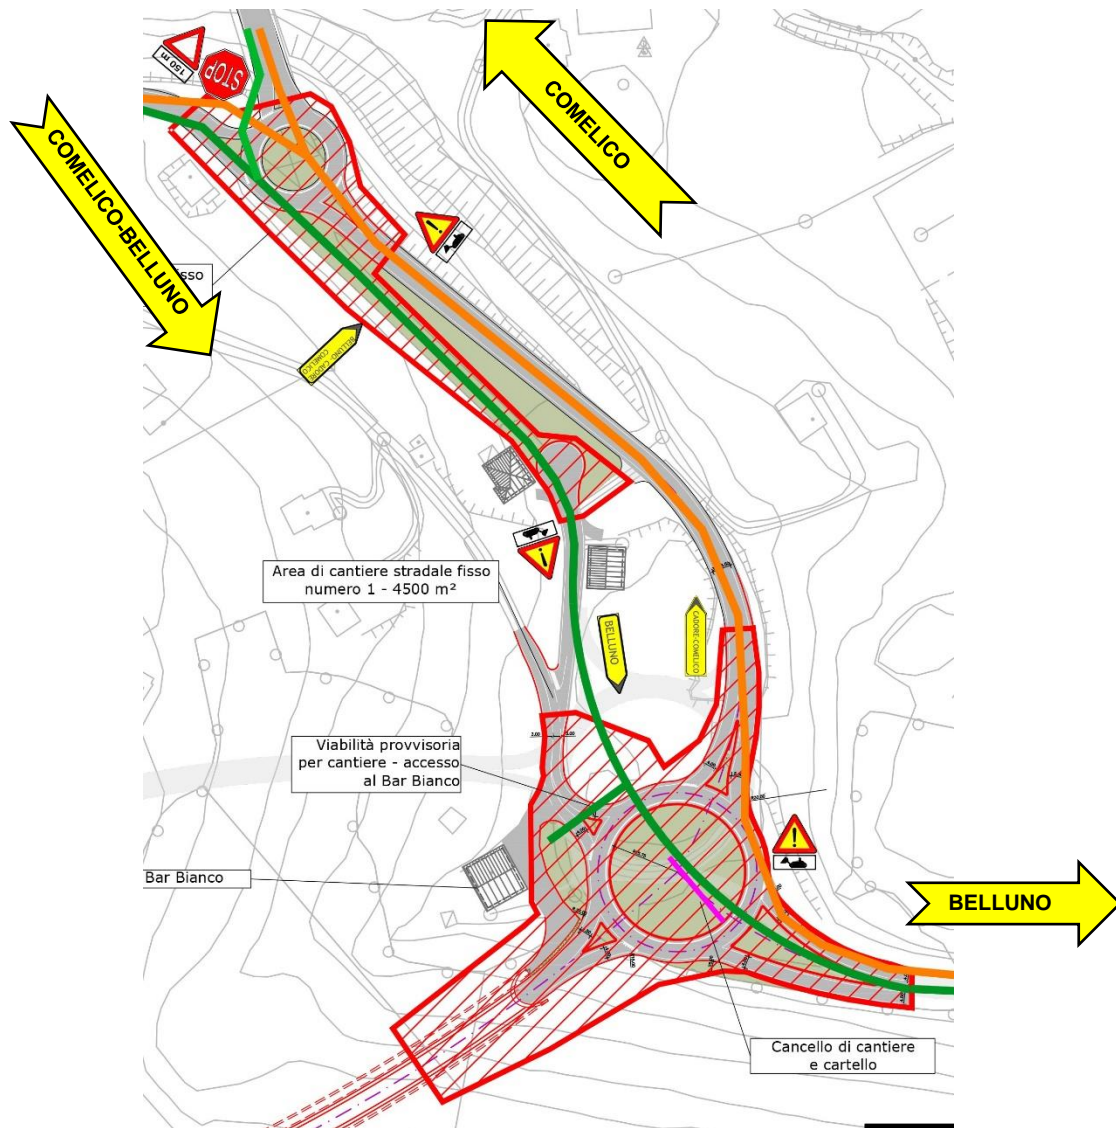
Direzione dei flussi di traffico ed area di cantiere stradale fisso numero 1
